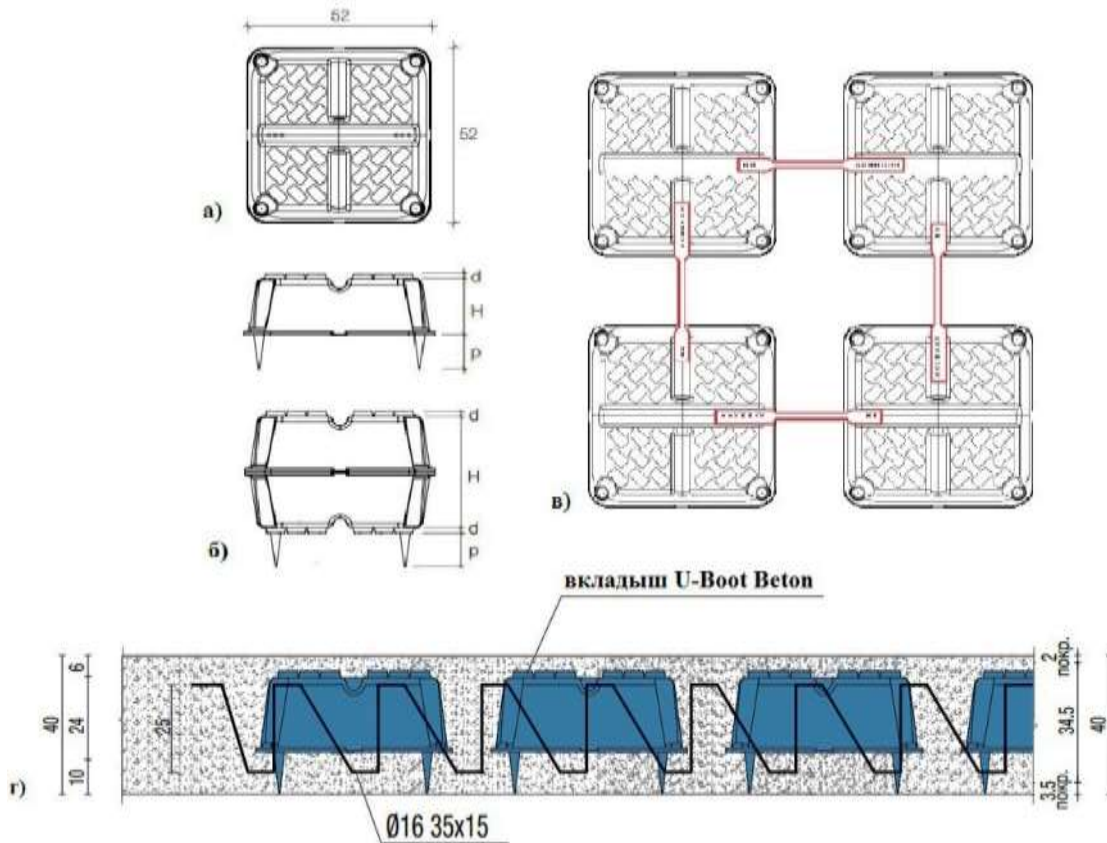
Особенности конструкции перекрытий по технологии U-Boot Beton: а) вид вкладыша в плане; б) вид вкладыша в поперечном сечении; в) объединение вкладышей муфтами; г) перекрытие с вкладышами
